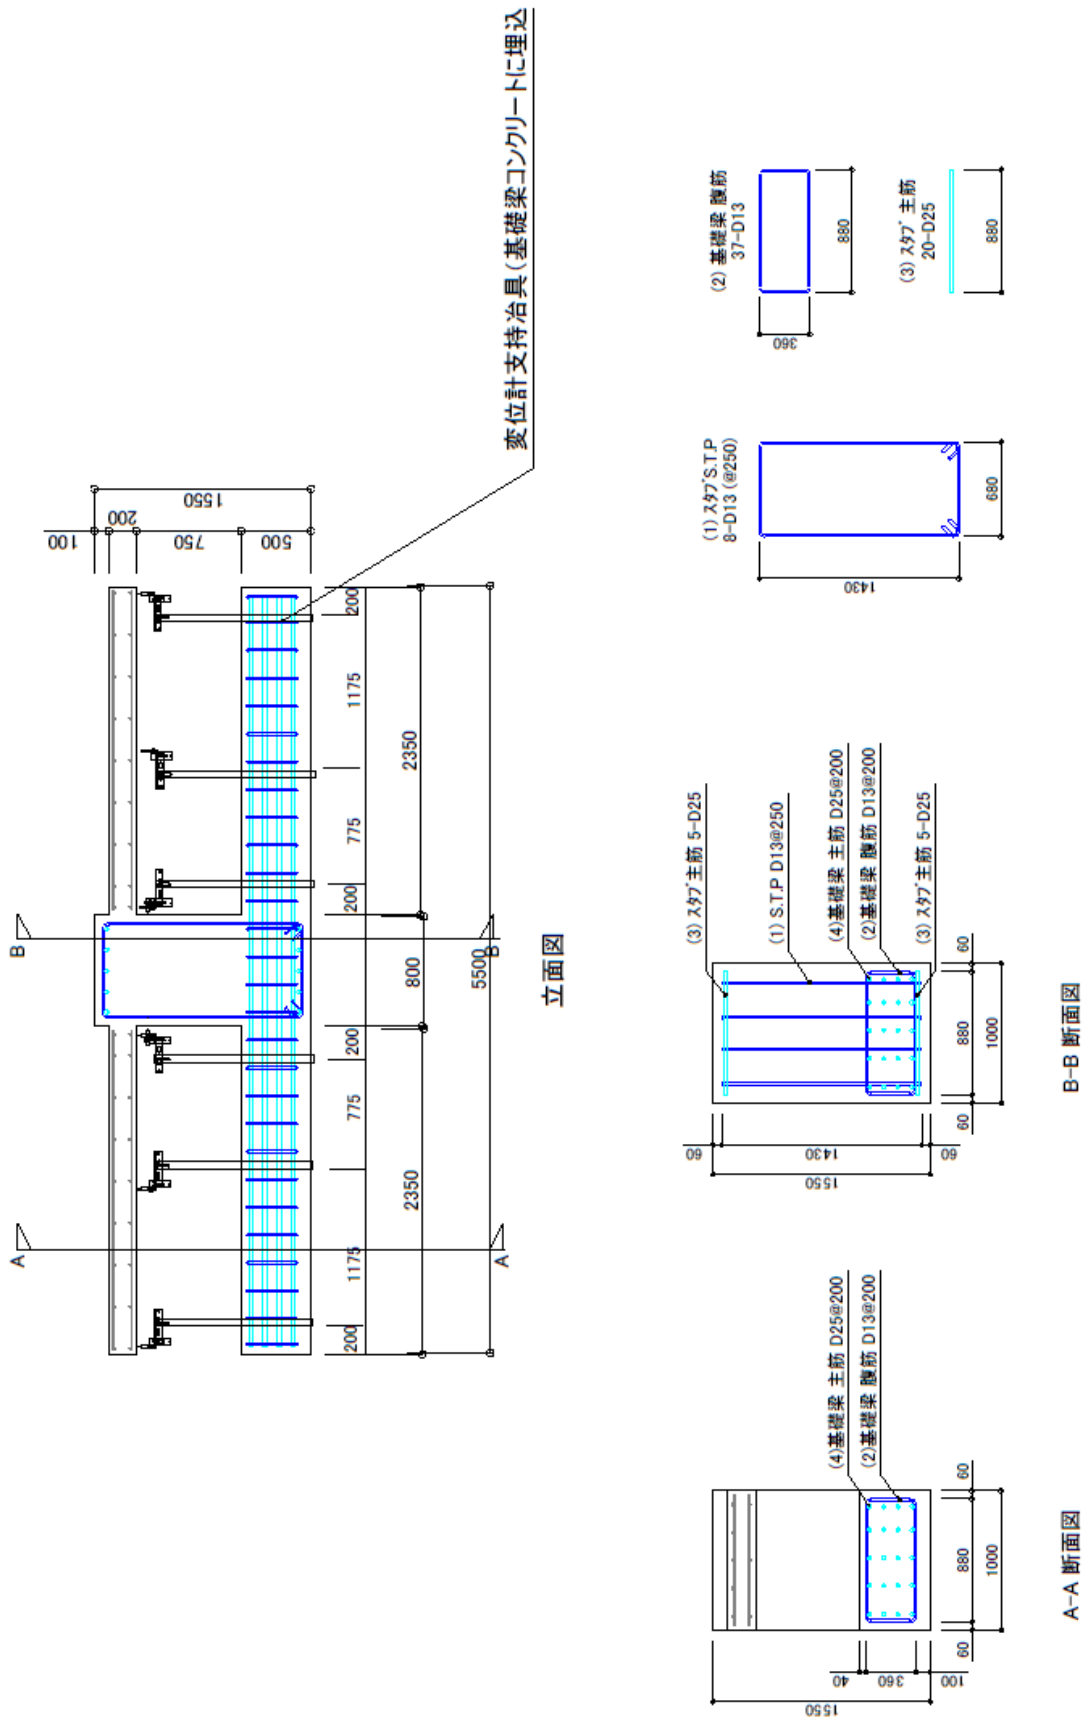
基礎梁および梁の配筋図 (CA, CB 試験体)
